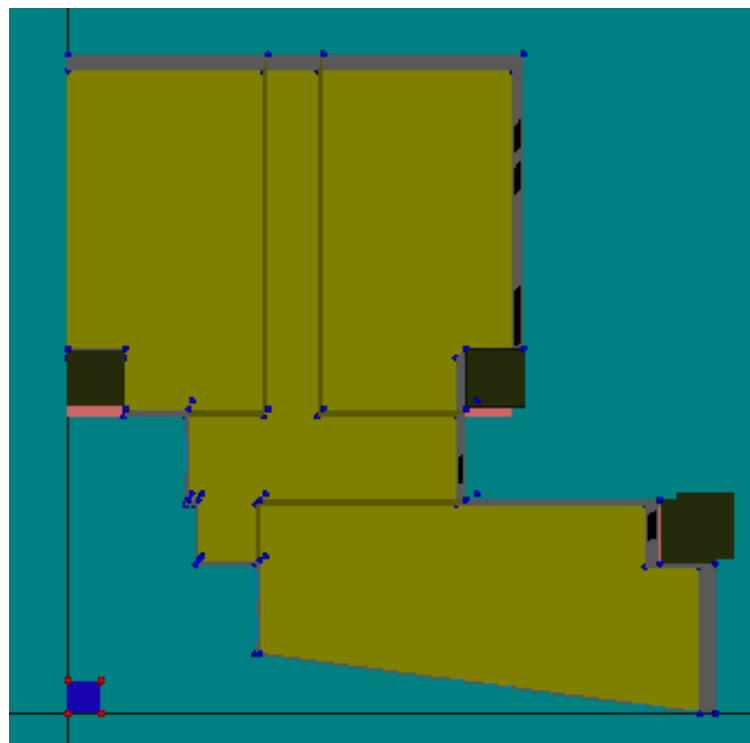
Vista planta de la planta sótano. Fuente: Propia, HULC.
